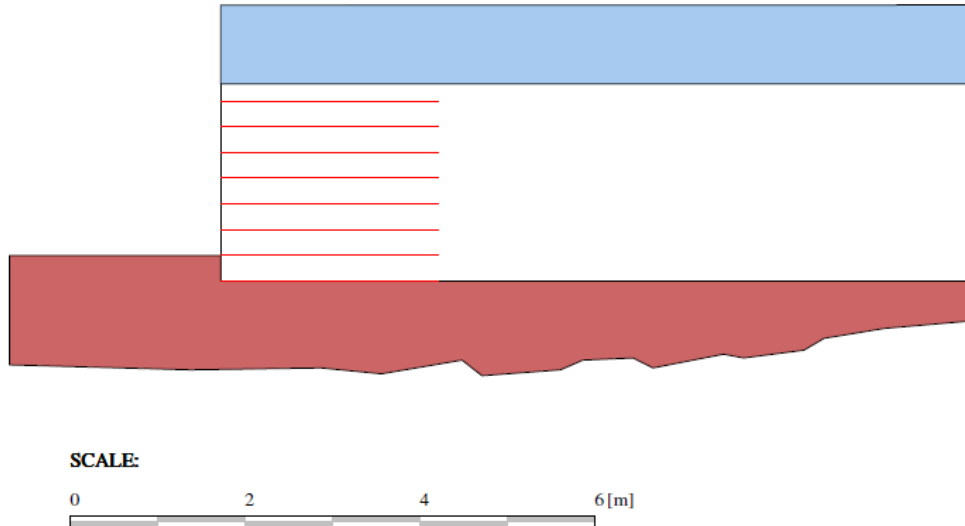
DISPOSICIÓN DE REFUERZO DE GEOMALLA EN GEOMETRÍA DE MURO DE SUELO REFORZADO
